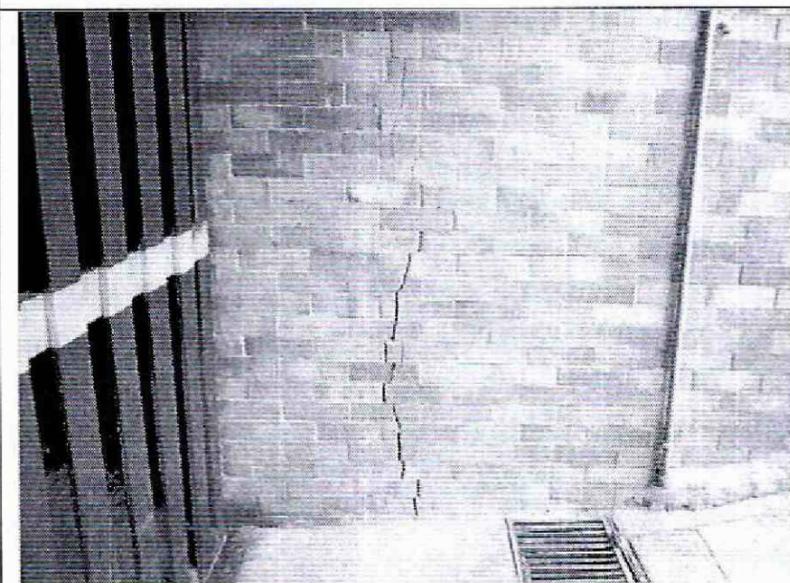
Grieta vertical del muro de la entrada vehicular.
